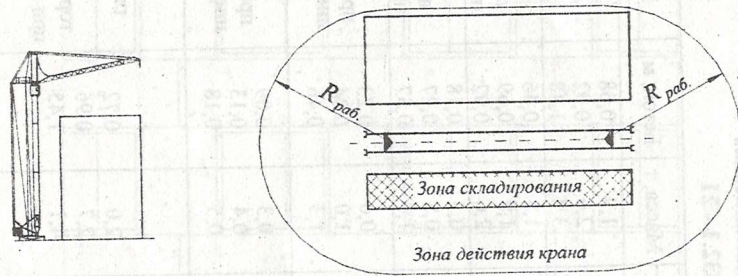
Монтаж железобетонных конструкций одним башенным краном
